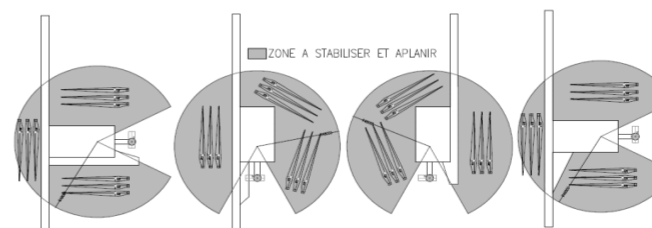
& tableau 2 : Exemples de stockages et dimensions
